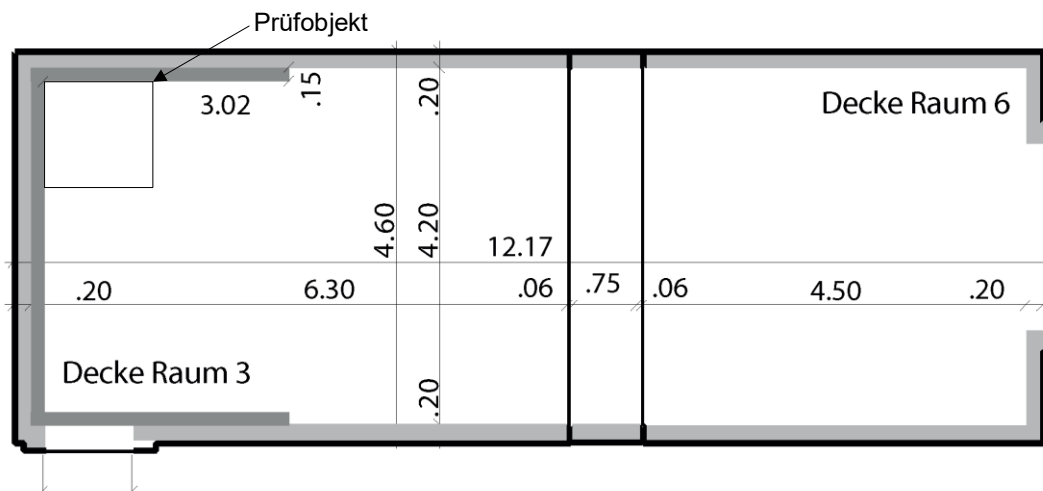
Grundriss des Prüfstands mit Positionierung des Prüfbjektivs auf der Decke von Raum 3
